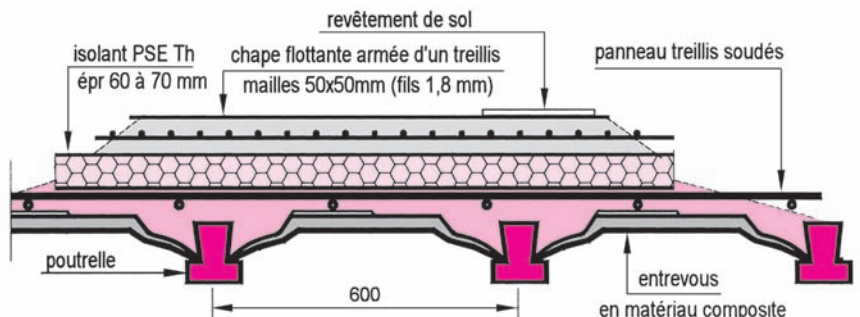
Plancher sur vide sanitaire avec dalle flottante sur isolant incompressible de type PSE Th SC1
